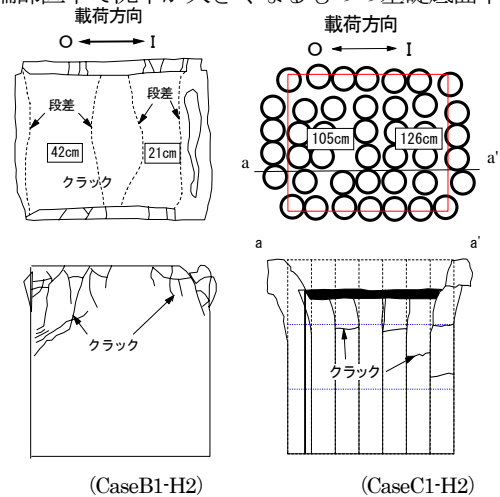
固化体の損傷状況 (上: 平面図, 下: 側面・断面図)
